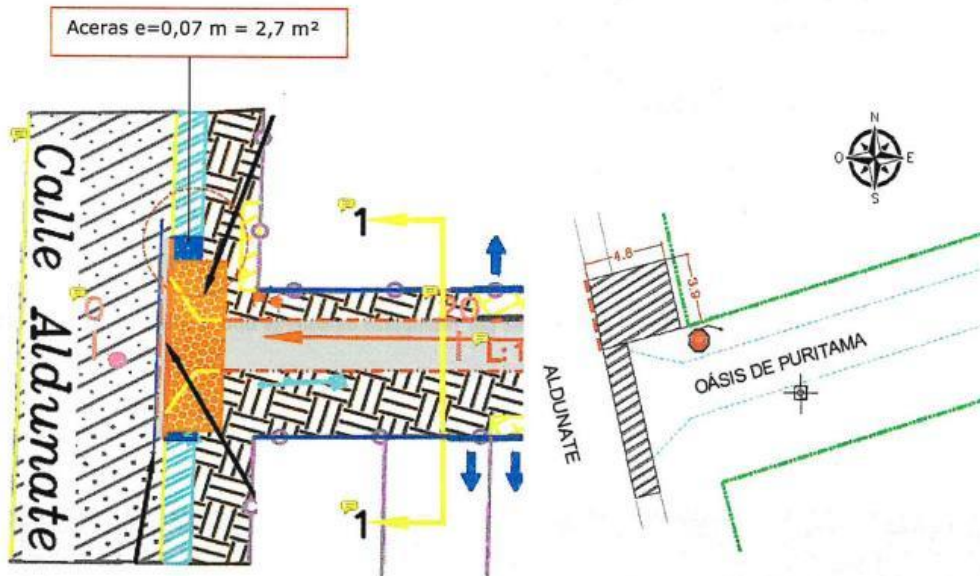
Disminución de aceras hormigón e=0,07 m reemplazadas por aceras de hormigón e=0,14 m en acceso vehicular en encuentro a calle Aldunate con Pasaje Oasis Puritama proyectado, lado norte.
